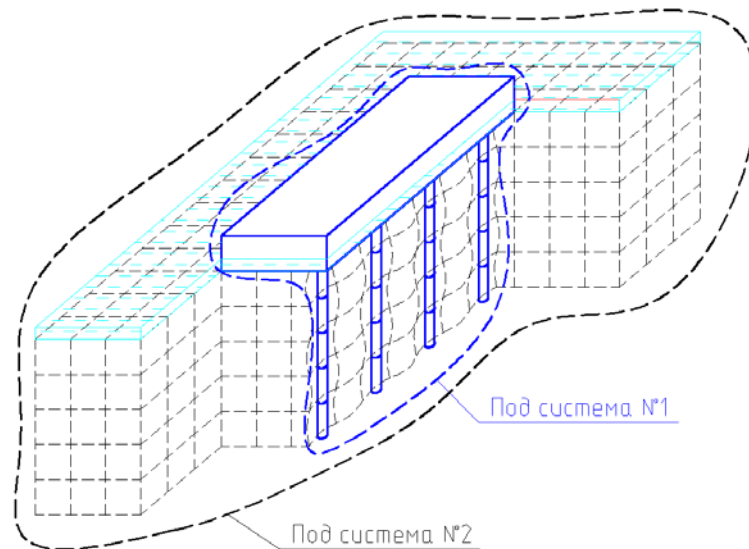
Система ГПА – Фундамент – грунтовое основание
